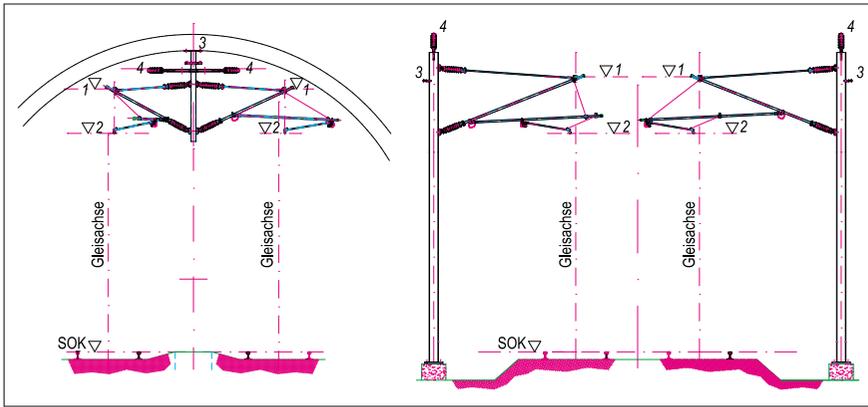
Querprofil im Tunnel (*links*) und auf der freien Strecke (*rechts*).
